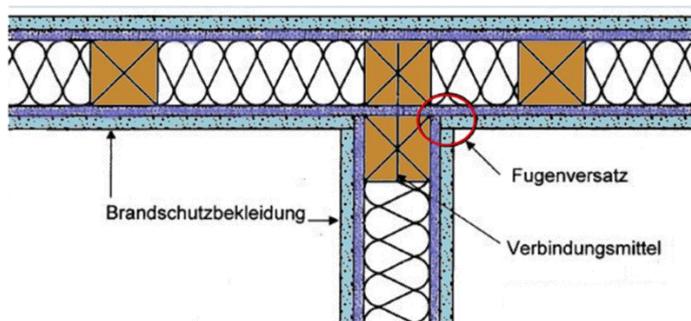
Anschluss tragende, raumabschliessende Wand an durchlaufende Wand mit zusätzlichem Stiel, stumpf gestossener Bauteilanschluss (Horizontalschnitt) [Muster-Richtlinie 23.05.19]
